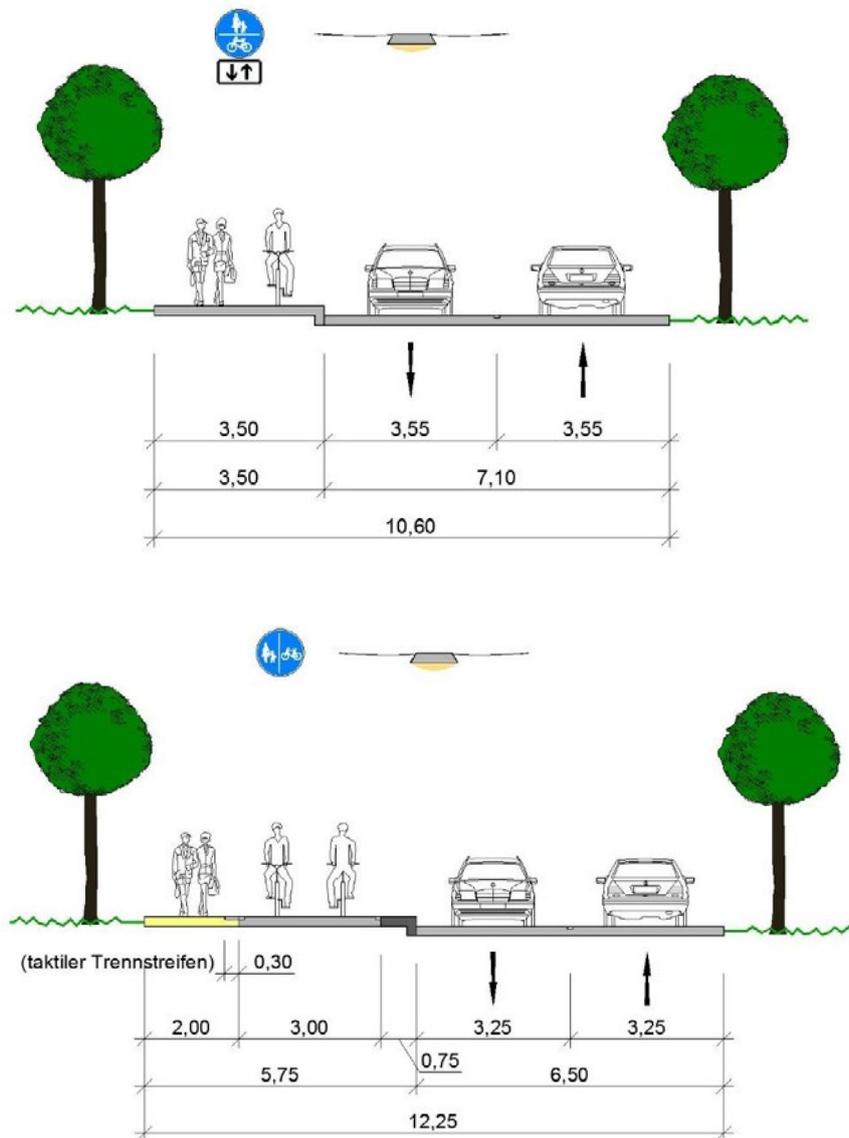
Bottroper Straße (Zeichenbahn – Hornstraße) – Bestand (oben) und Planung (unten)
